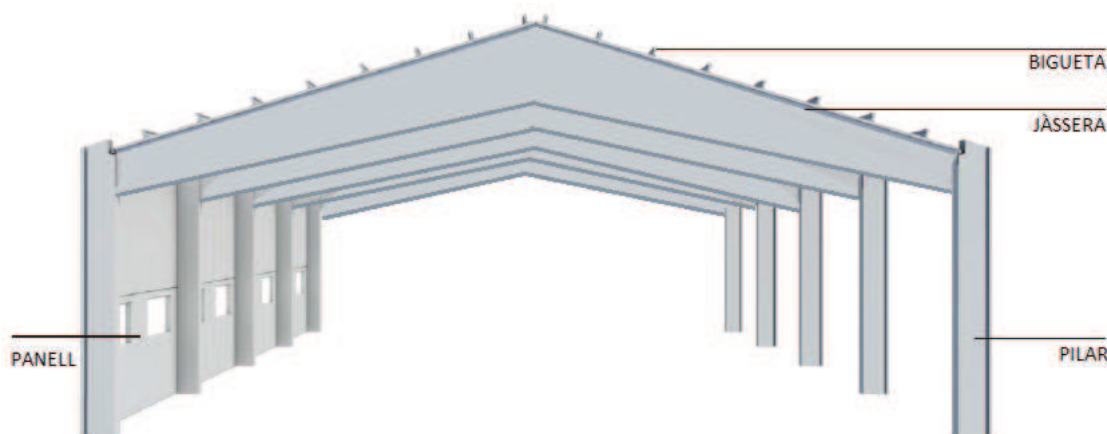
Pòrtic utilitzat en la construcció de les naus.
